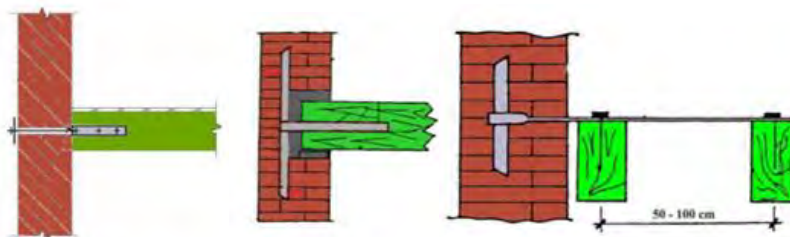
Legarea pereților cu planșeele cu ancore [19]
